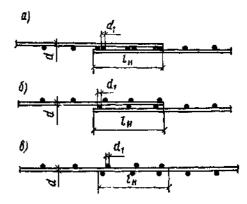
Стыки свариых сеток внахлестку (без сварки) в направлении рабочей арматуры при выполнении последней из стержней гладкой арматуры
